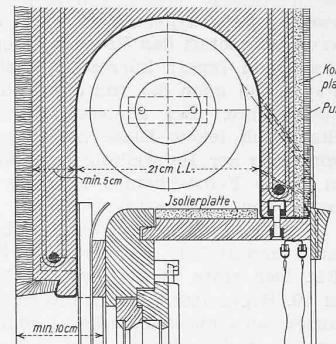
Stahl-Rolladenkasten «Norm», 1:8.
